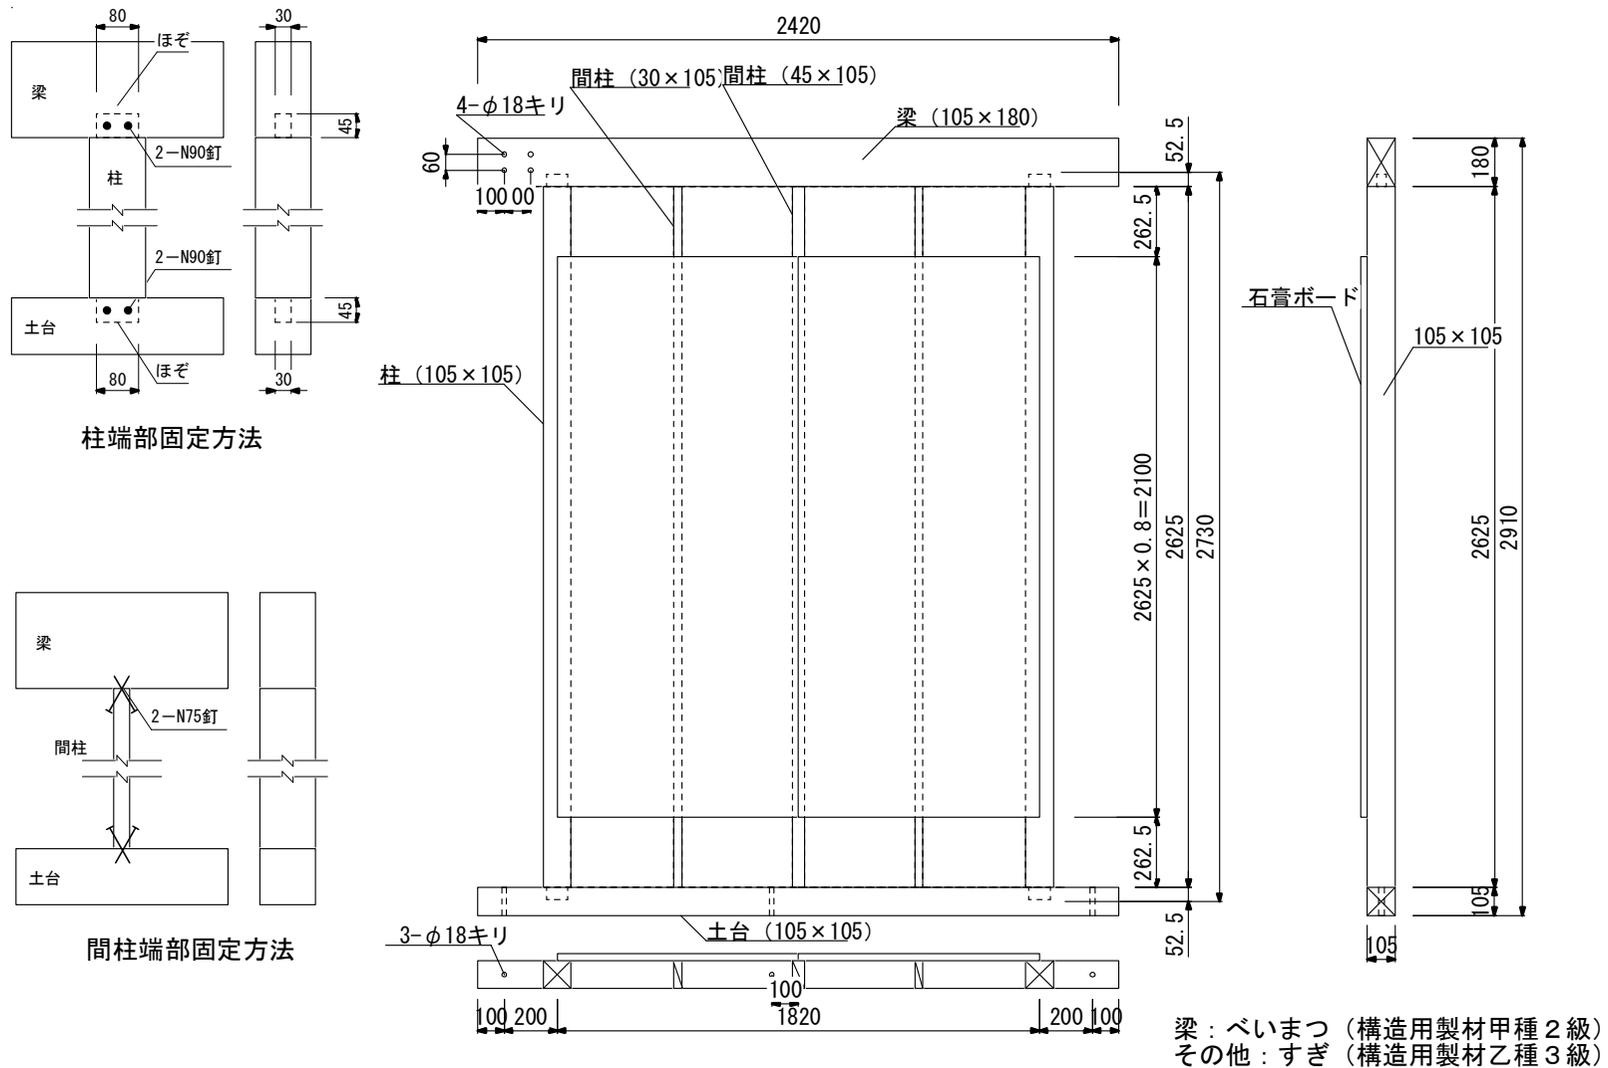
試験体の形状・寸法 (寸法単位: mm)
